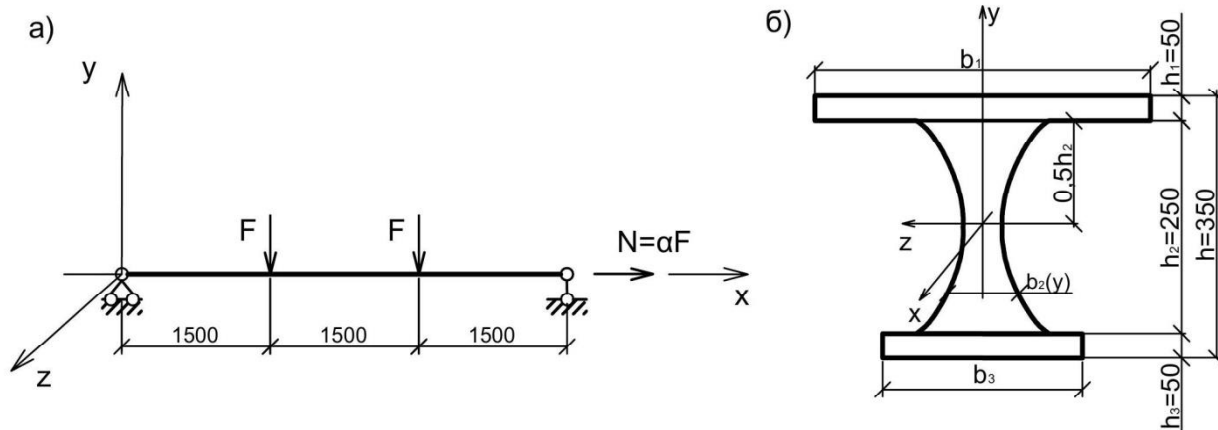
К расчёту деревянной балки: а) расчётная схема балки; б) поперечное сечение балки
